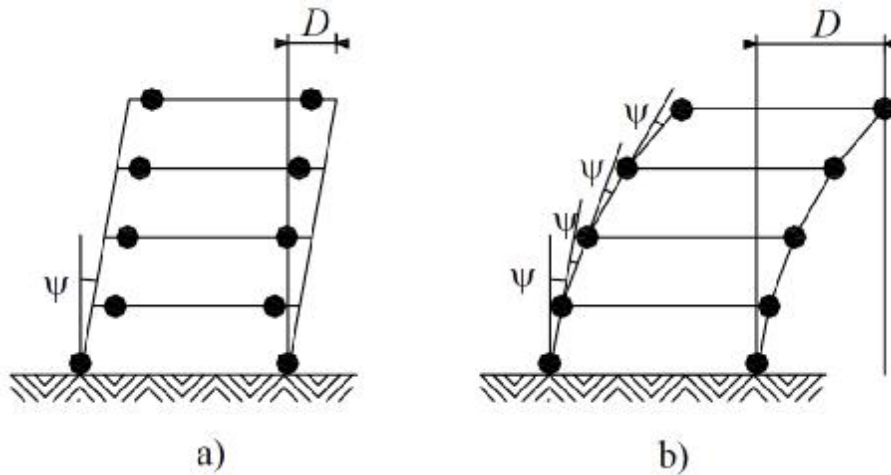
a) L'objectif de projet "poutres faibles – poteaux forts" b) Les rotules plastiques dans les poteaux entraînent des effets du second ordre plus importants.
